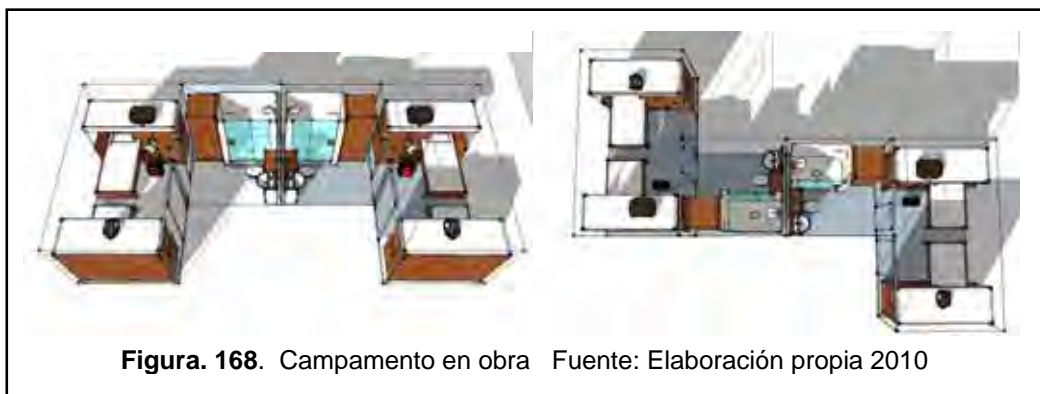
Campamento en obra Fuente: Elaboración propia 2010
